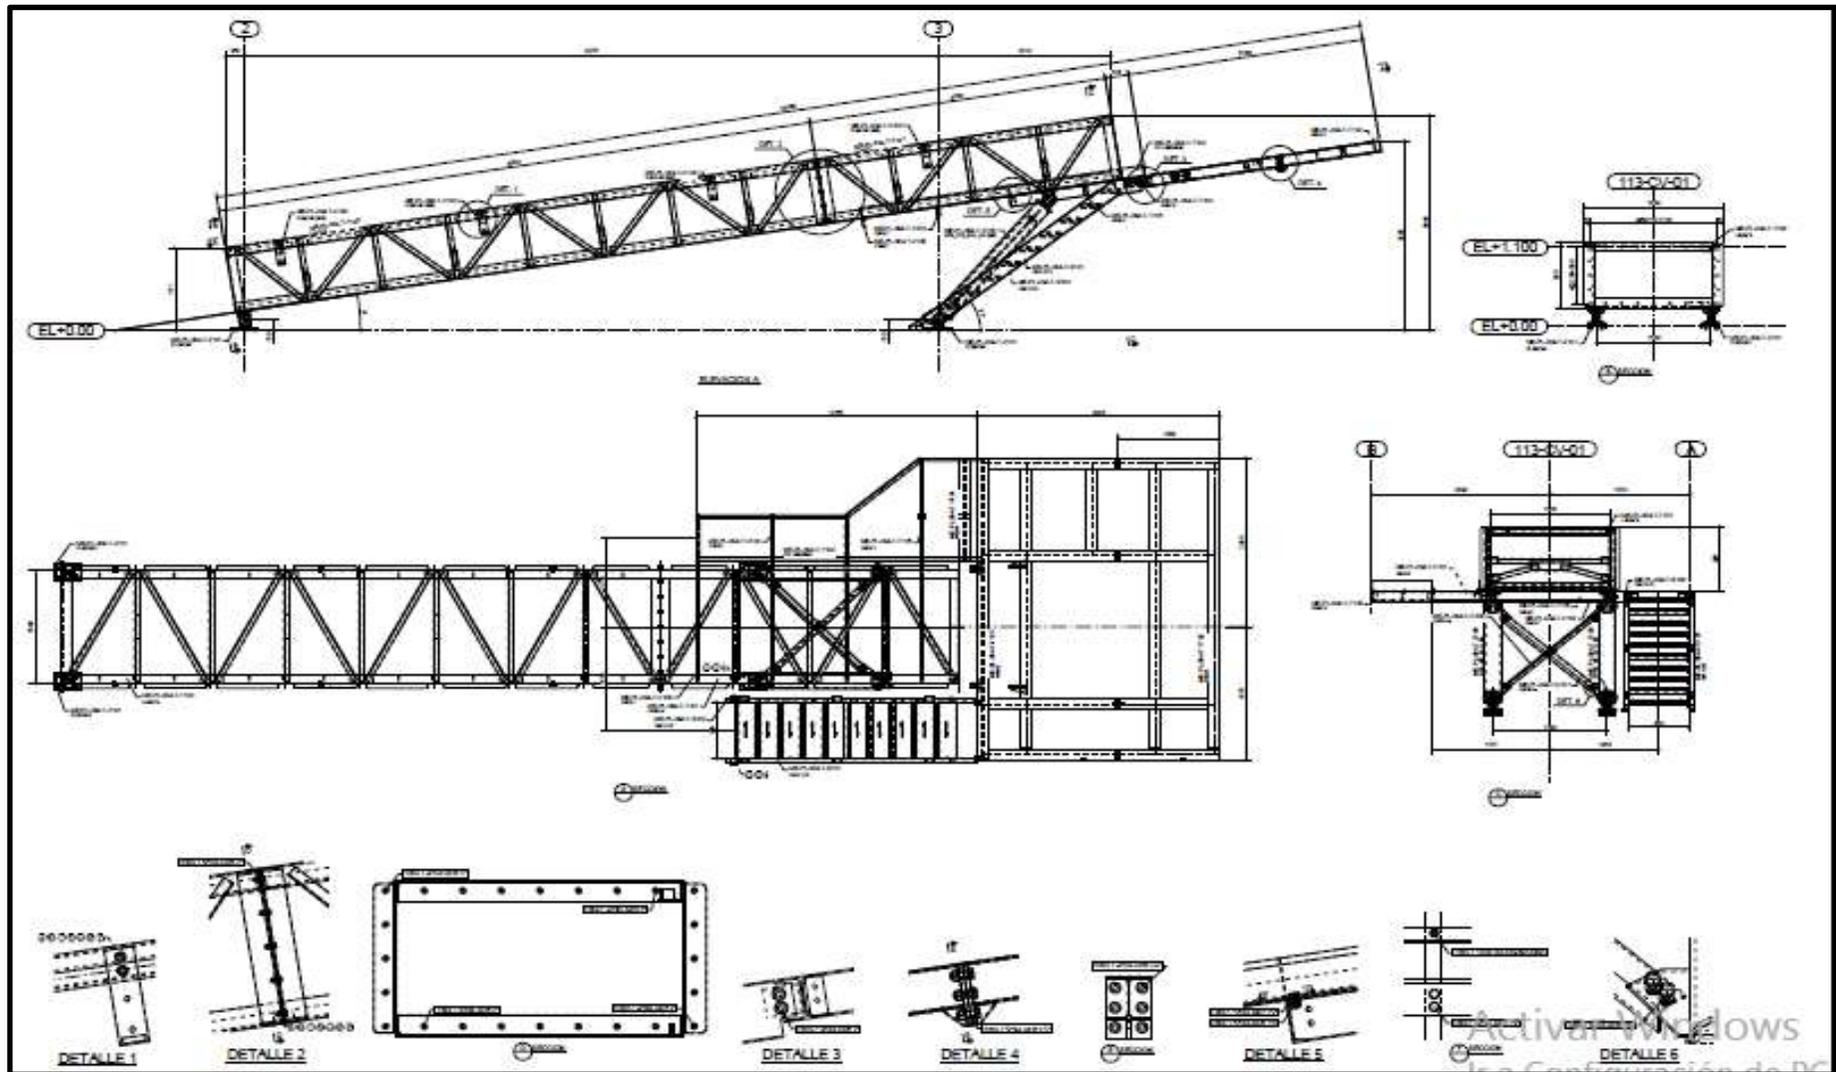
PLANO 2 - ESTRUCTURA METÁLICA DE LA FAJA TRANSPORTADORA
